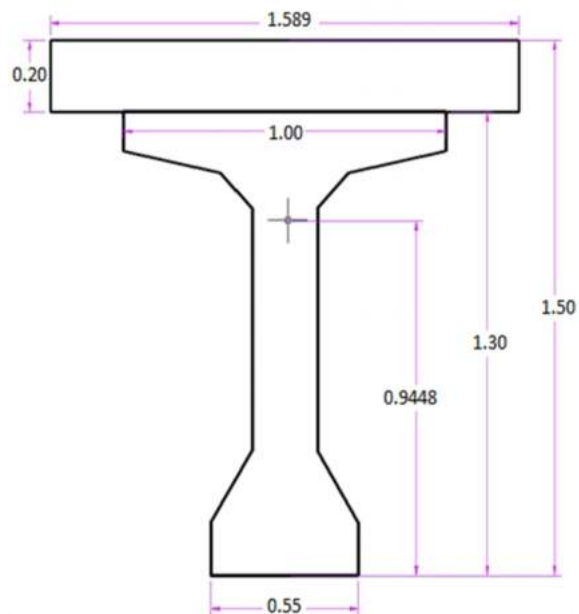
les dimensions de la section de la poutre+l'hourdis
